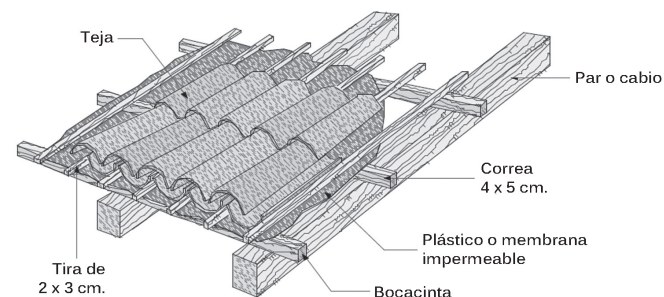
Detalle del revestimiento de una cubierta con teja árabe.
